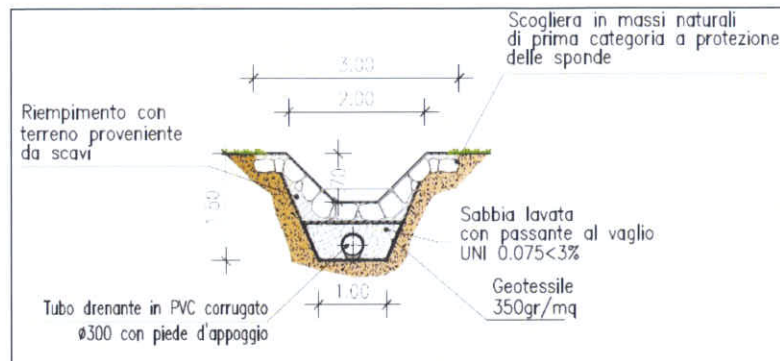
area “Roncaglie”, canale con drenaggio alla base – sezione tipo B.
